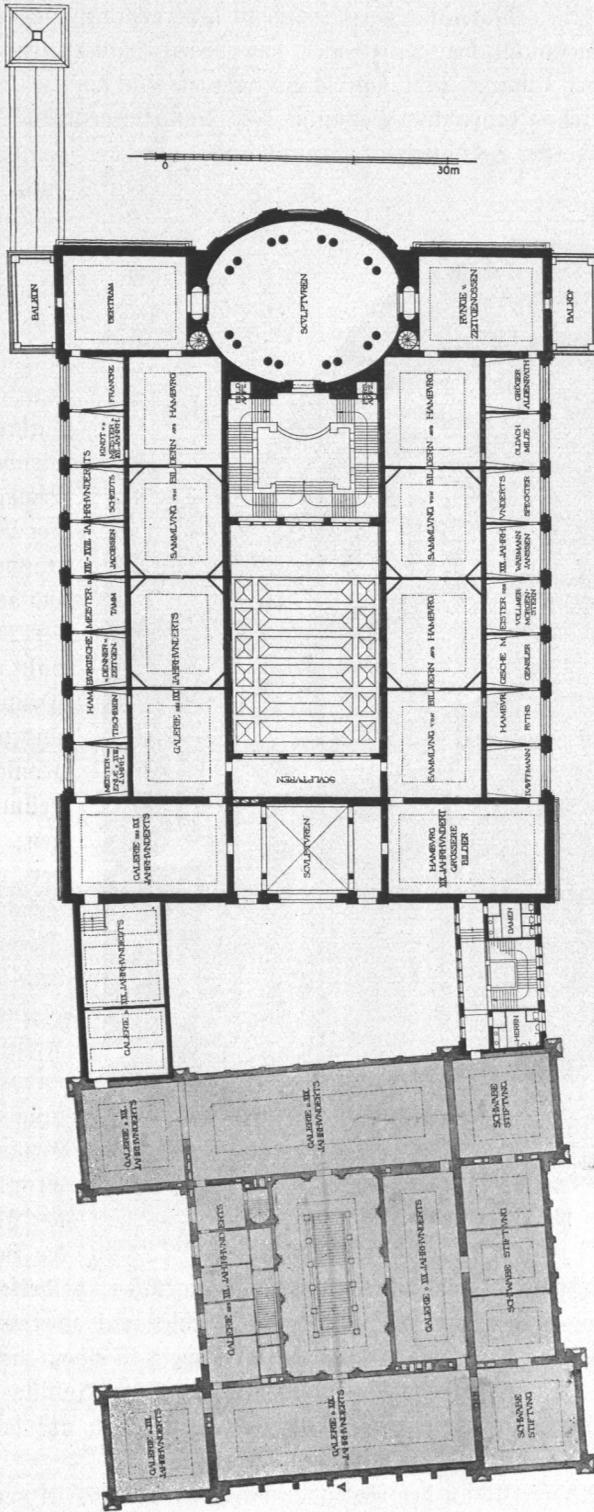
Rundhalle, Obergehoß. Grundriß.
